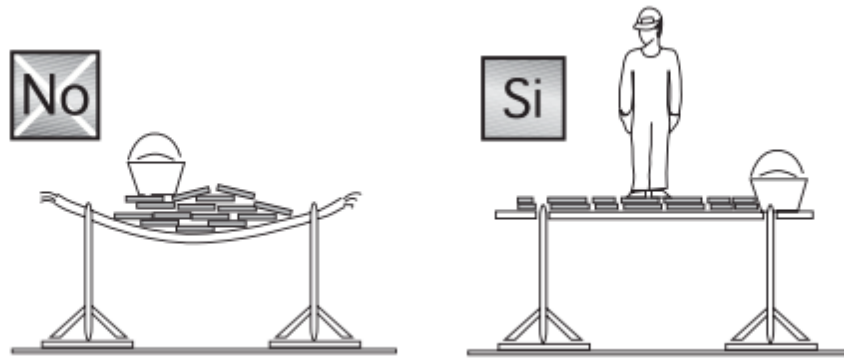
Carga de material para un andamio. Fuente: Nota Técnica trabajos en alturas, protección.
